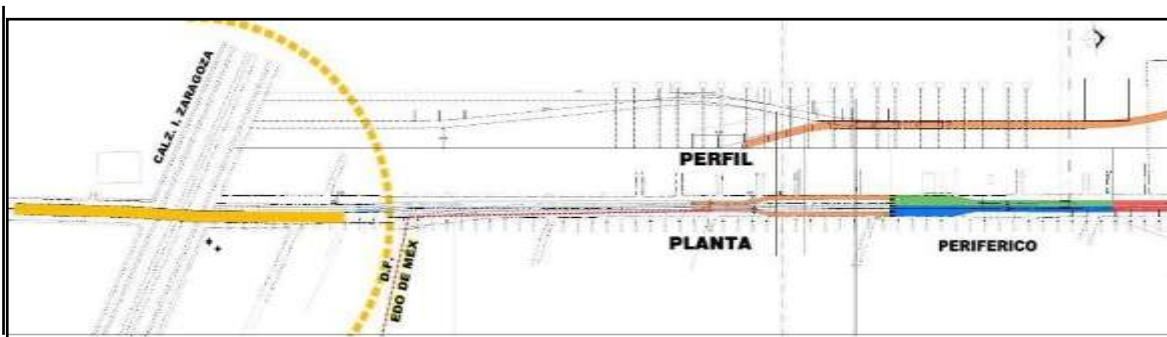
Planta y Perfil Calle 7 - Calz. I. Zaragoza.
